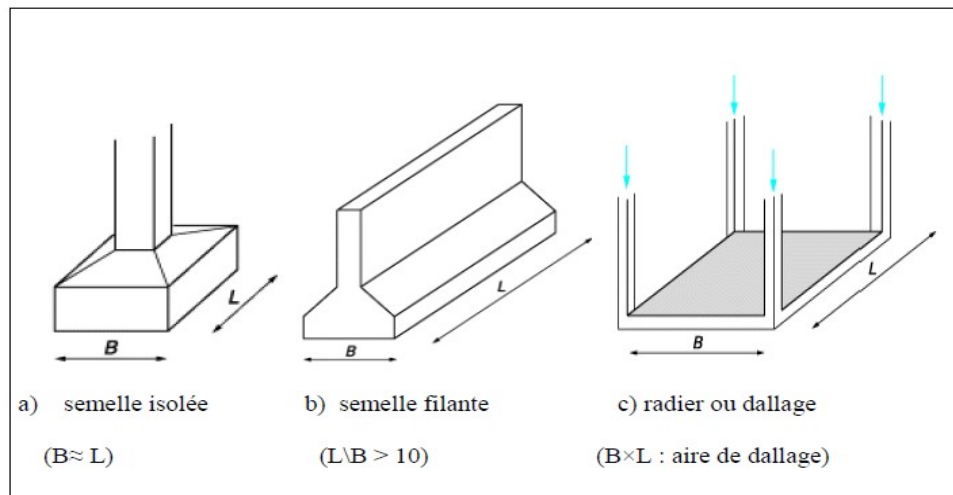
Schéma représentant le type de fondation suivant la hauteur d'encastrement et la largeur de semelle. [4]
